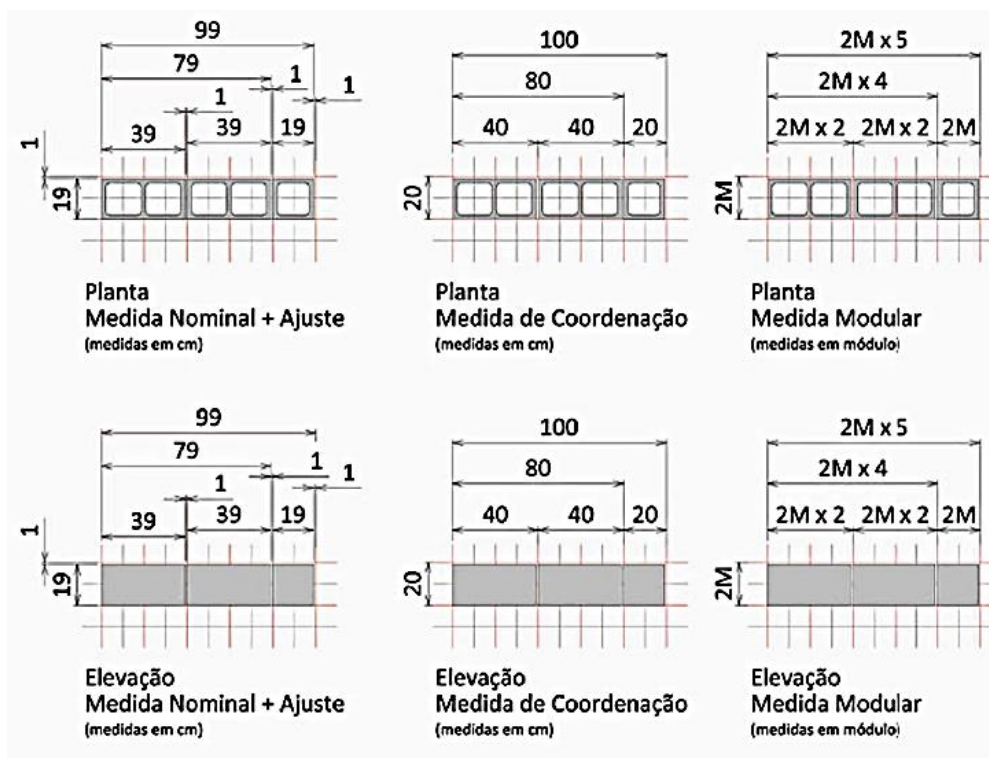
Exemplo de aplicação da modulação - horizontal e vertical
